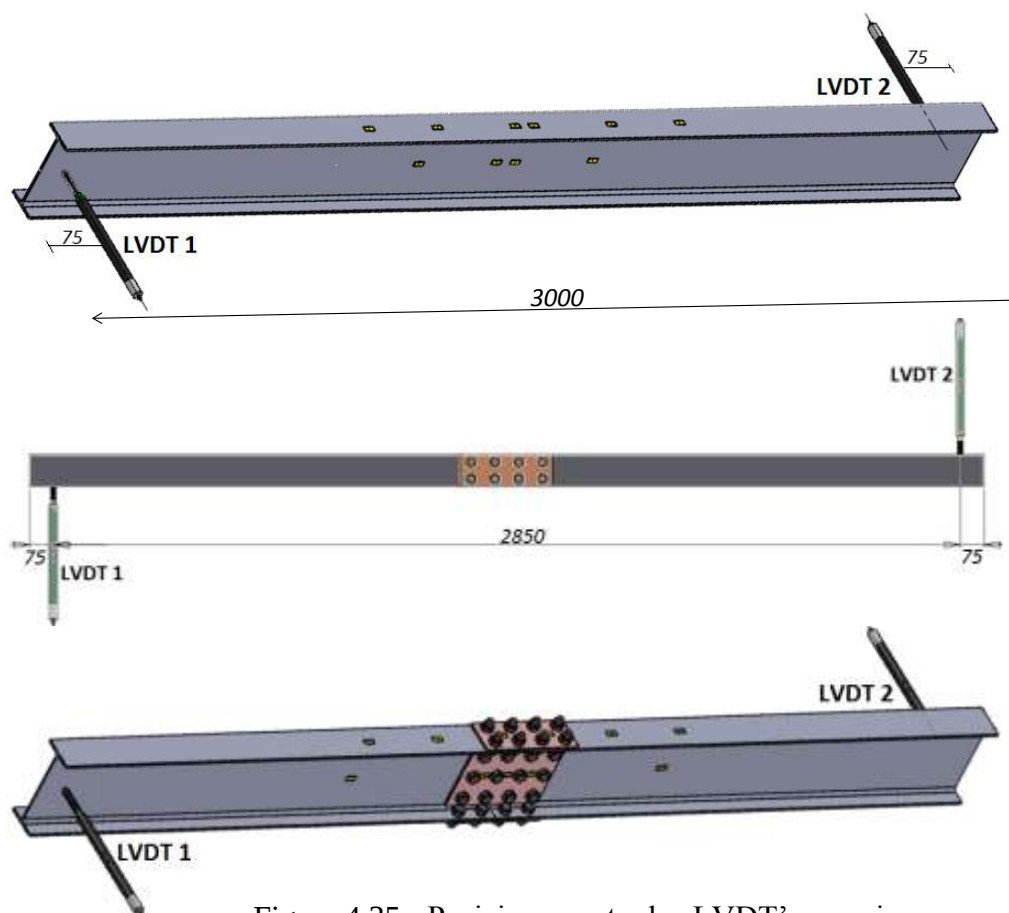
Posicionamento dos LVDT's nas vigas
